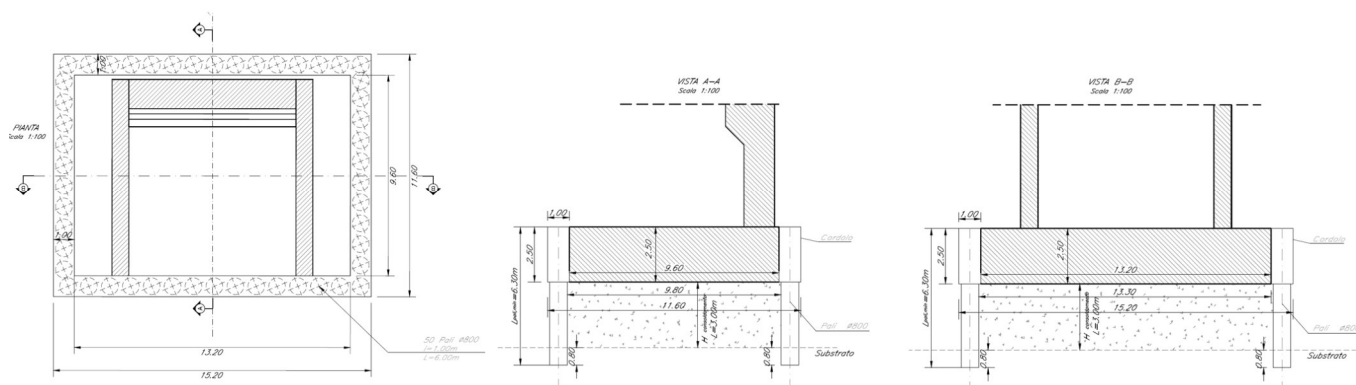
Pianta e sezioni pozzo di fondazione costituito da coronella rettangolare di pali D800 interasse $i=1.00$ m
